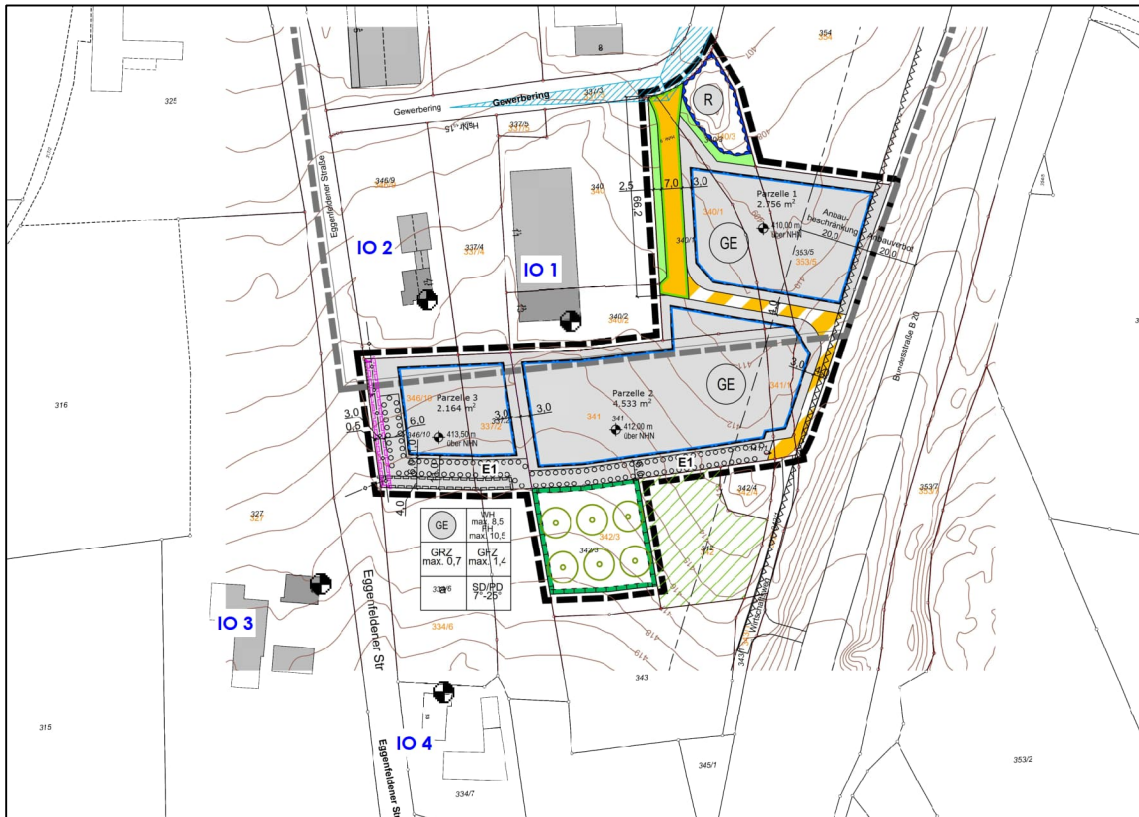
Lageplan mit Eintragung der maßgeblichen Immissionsorte IO
